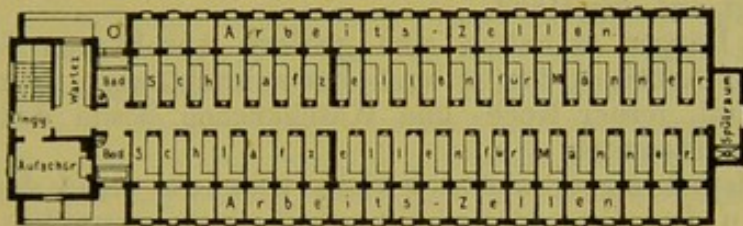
St. Clare's Union Asyl in London. Grundriss.
